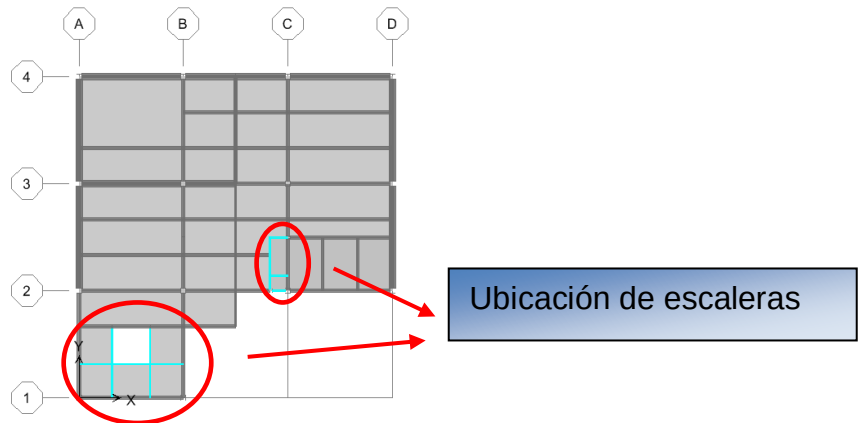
Planta donde se muestra la ubicación de las escaleras
